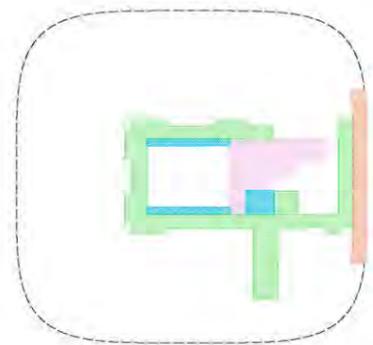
地上 14 層平面圖 (比例圖 1/400)
